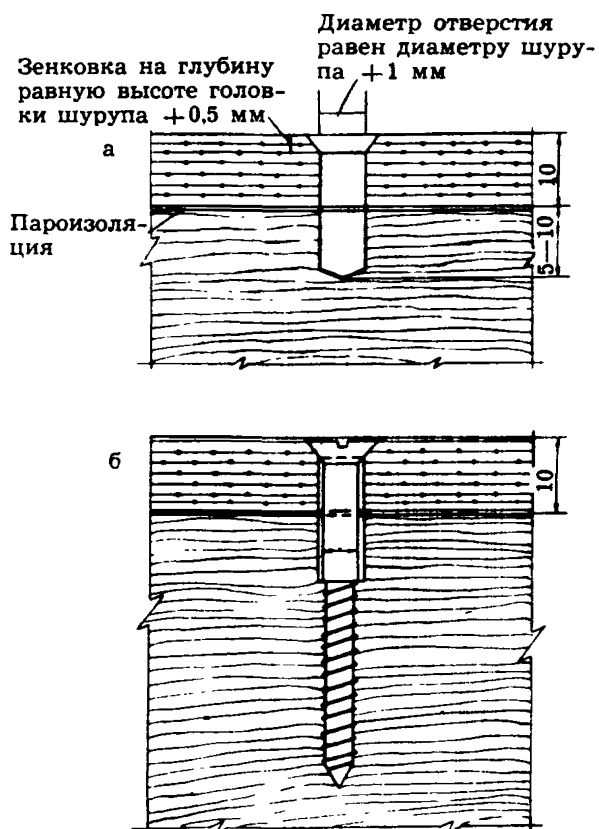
Схемы установки шурупов: а — отверстие для установки шурупа; б — вставленный и завернутый в ребро каркаса шуруп
